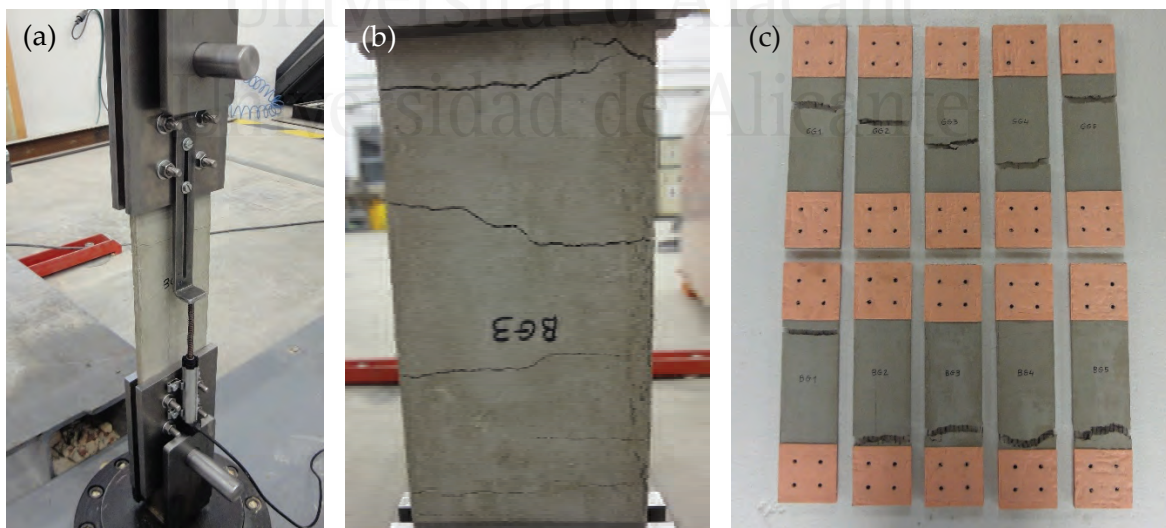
Ensayo a tracción de las probetas de FRCM (a y b) y vista de los ejemplares tras las roturas (c).
